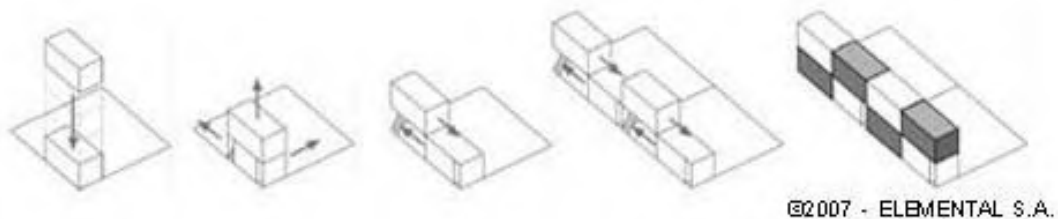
19 Penataan Massa Bangunan (Alejandro Aravena, 2003)
